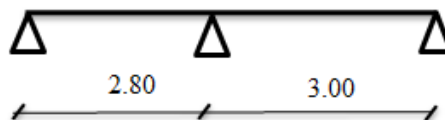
Poutrelle type 02 Plancher RDC (terrasse accessible)
